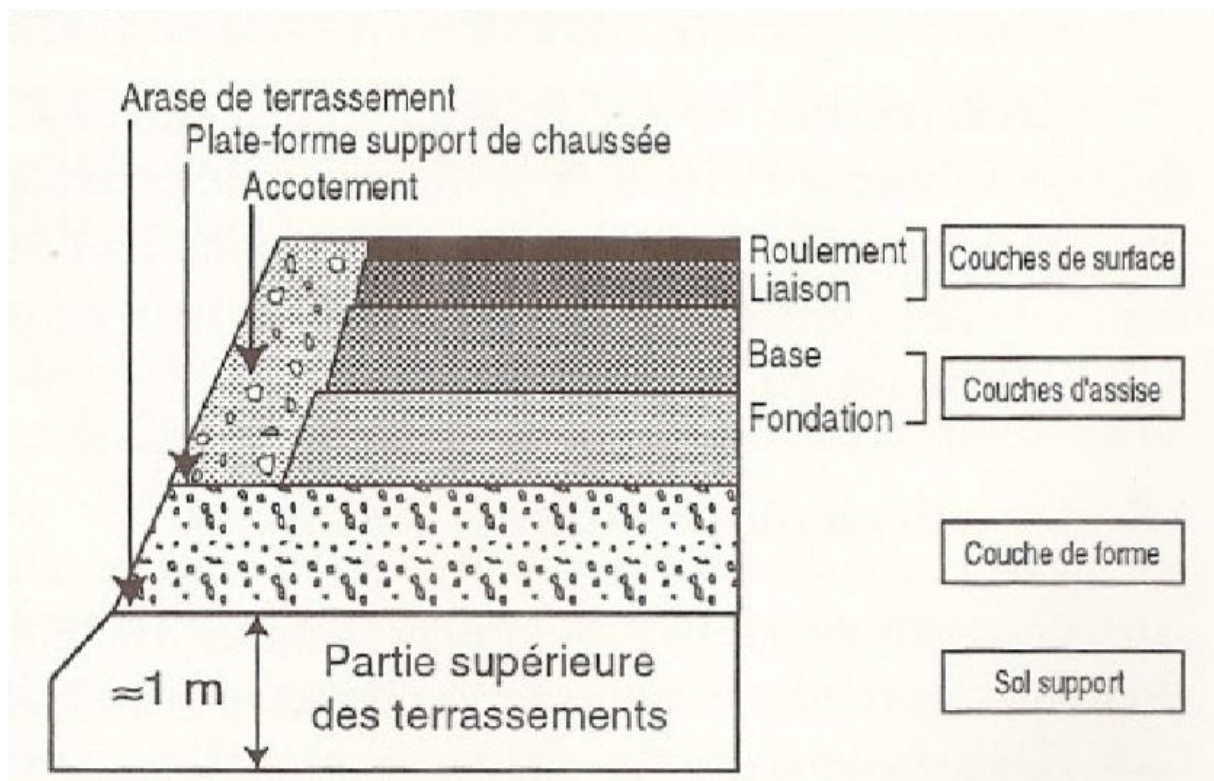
Elements constitutifs de la structure de chaussée (Michel FAURE, Routes TOME 2)
